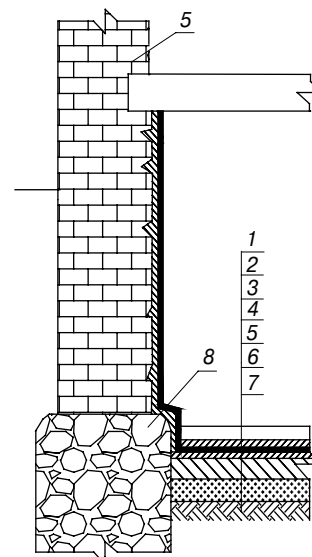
Сочетание фрагментированного барьера с поэтапно устраиваемой мембраной: 1 – монолитный, армированный дорожной сеткой бетон; 2 – защитный слой; 3 – рулонный гидроизоляционный материал; 4 – выравнивающая стяжка; 5 – подготовка из тощего бетона; 6 – уплотненный грунт
